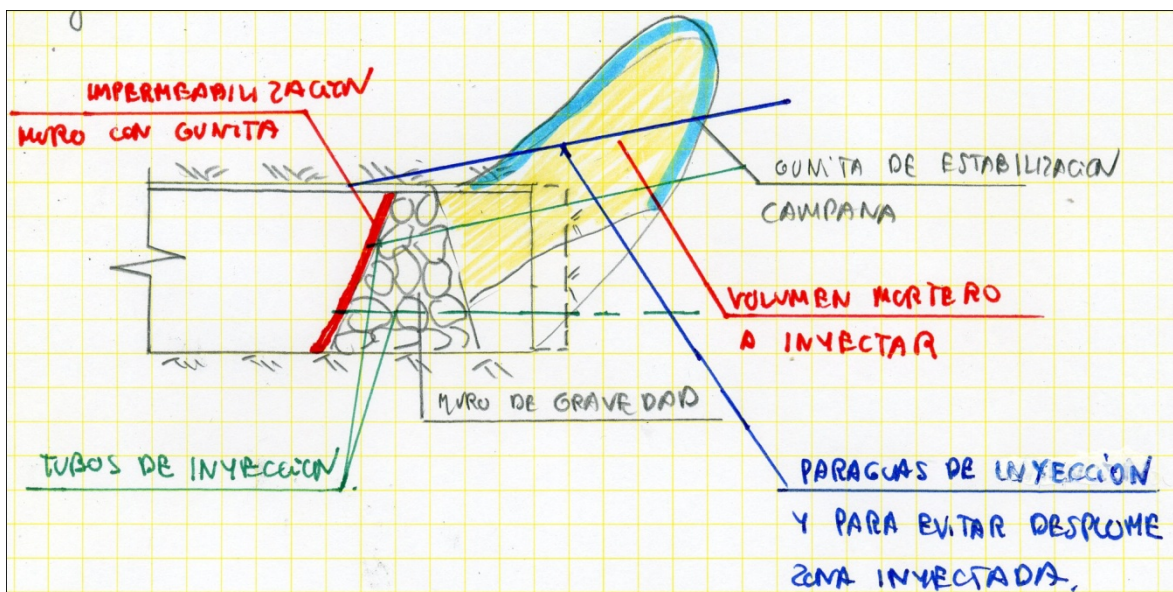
Tape de muro de gravedad con paramento gunita
